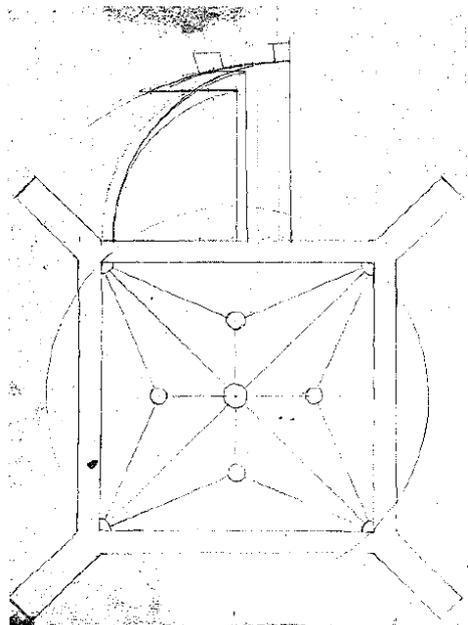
Plano de planta tratado Hernán Ruiz el Joven (1560).
